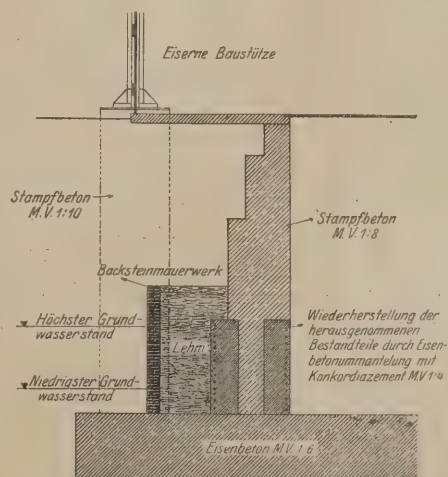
Becherwerksgrube einer Koksbrecherei.
